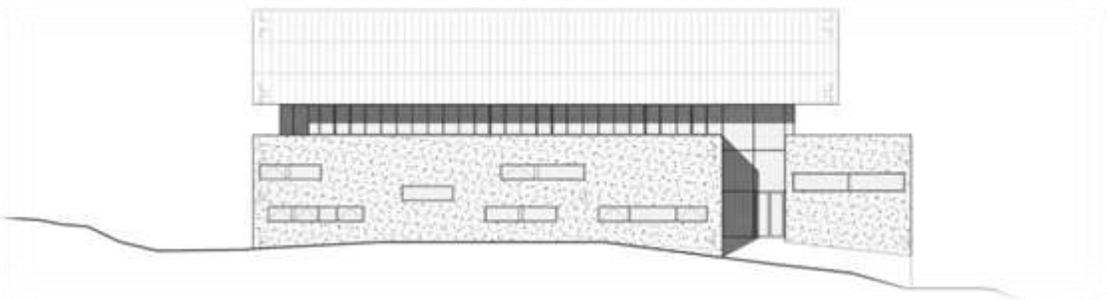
Fachado lateral. Fuente: Hervé de Chastenet
